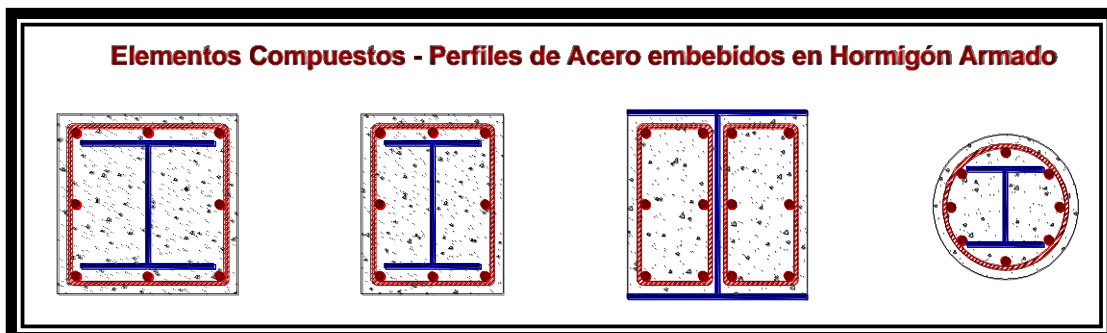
1: Elementos Compuestos con perfiles de acero embebidos en hormigón.
